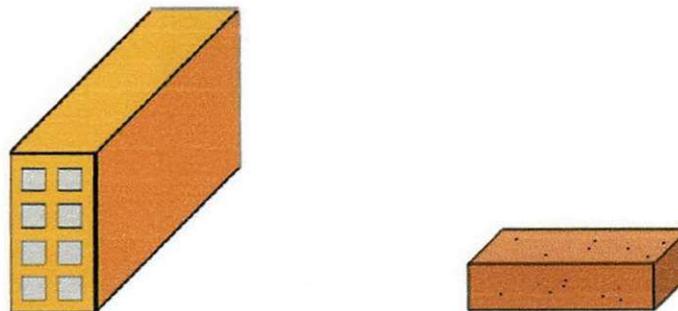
Bloco cerâmico vazado de vedação ("lajota") e tijolo cerâmico maciço.
